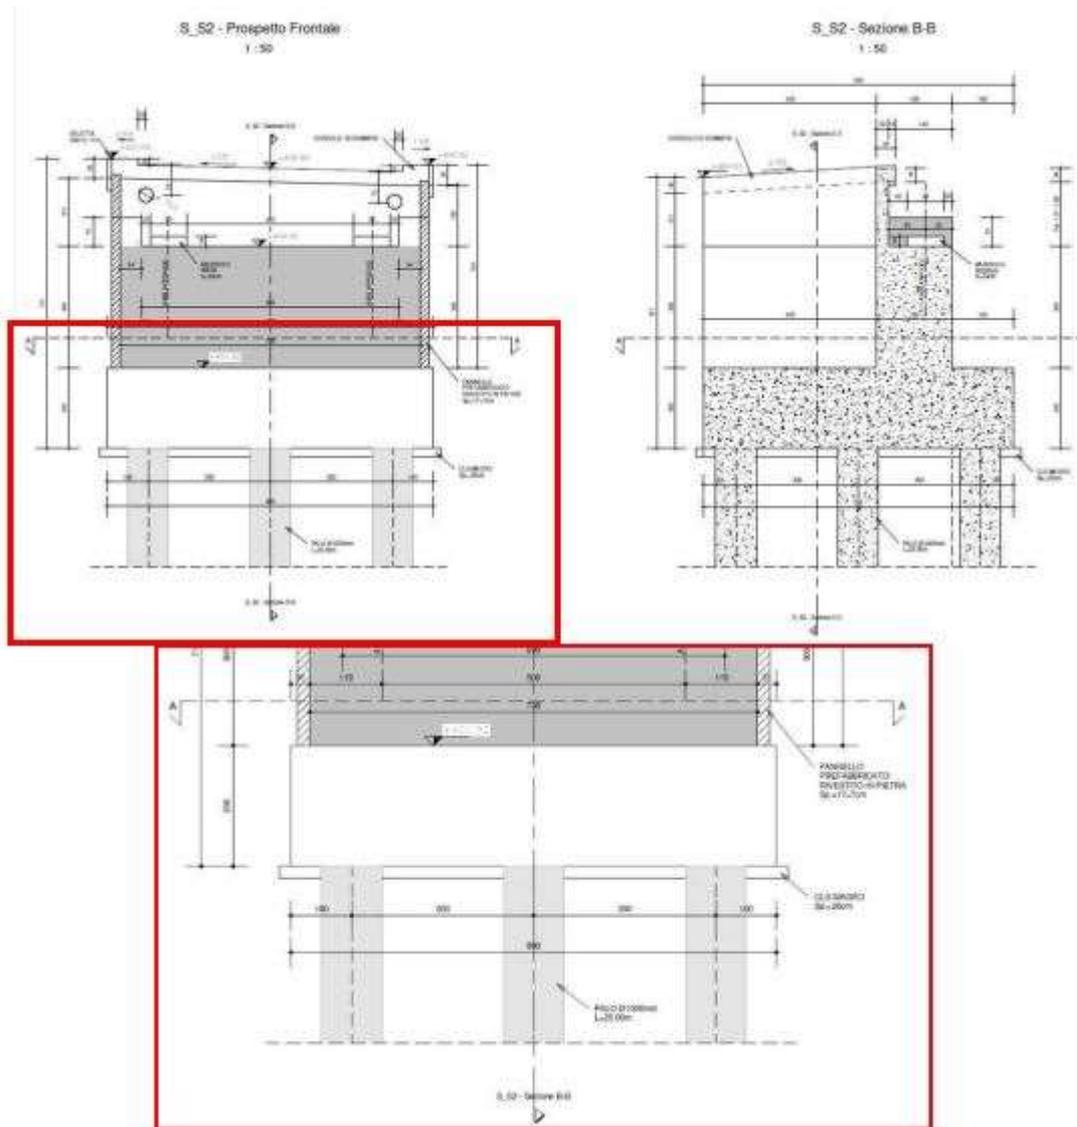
Spalla S2 - prospetto, sezione e dettaglio fondamenta
